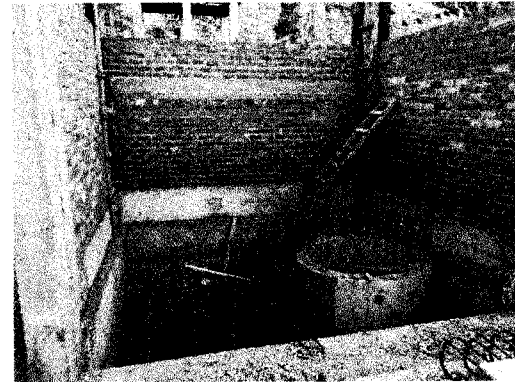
pruebas hidráulicas techo de ladrillo pastelero área de administración.
